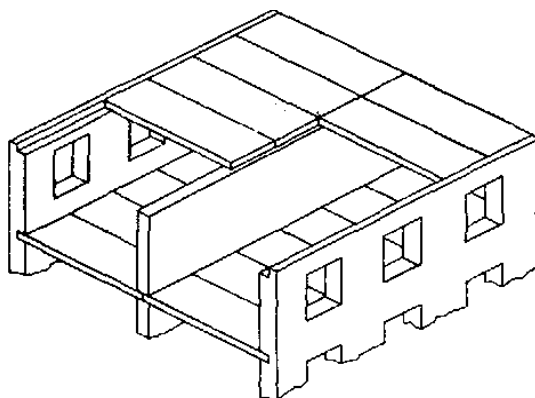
Конструктивная схема с самонесущими стенами, выполненная полностью из монолитного железобетона
